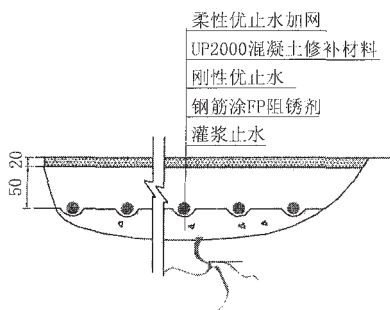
混凝土墙体渗漏水裂缝治理的构造示意
